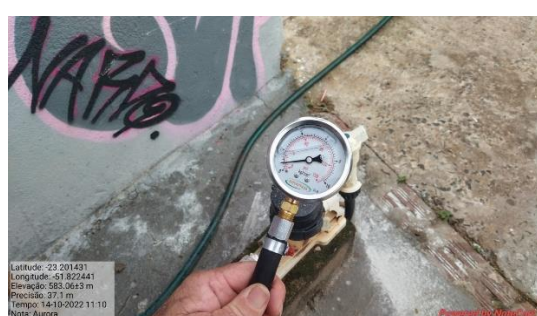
Ponto 01 - Ano de fabricação 2016. Foto 61: pressão = 11mca.
